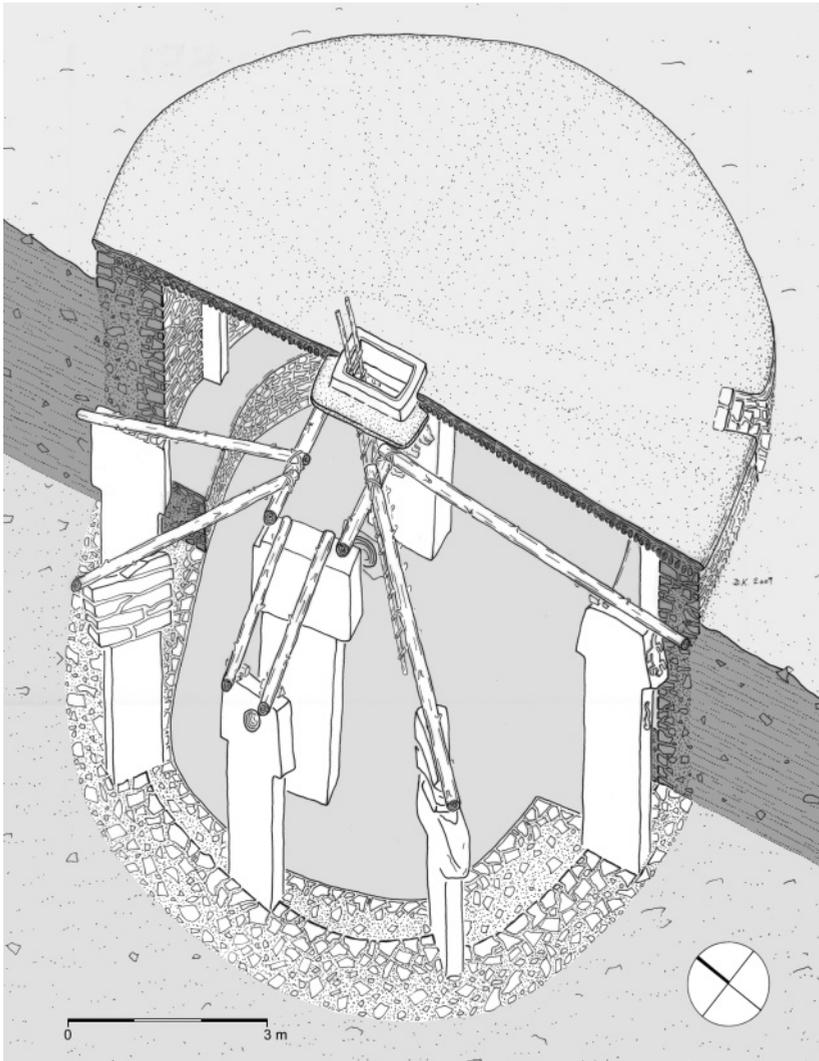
Göbekli Tepe, zeichnerische Rekonstruktion einer hölzernen Dachkonstruktion über dem Sondergebäude Anlage B (Abb. D. Kurapkat).
